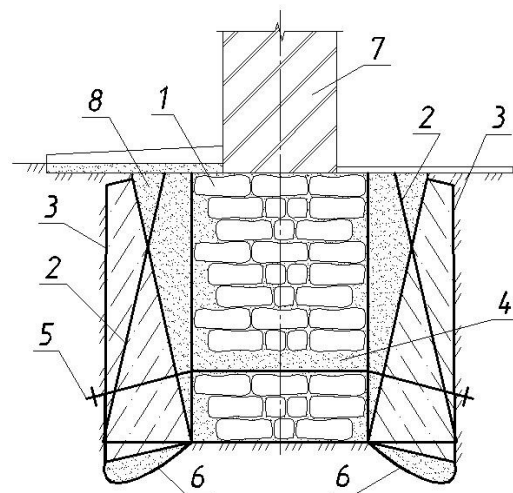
Збільшення опорної площі збірними залізобетонними елементами з обтисненням ґрунту основи:
